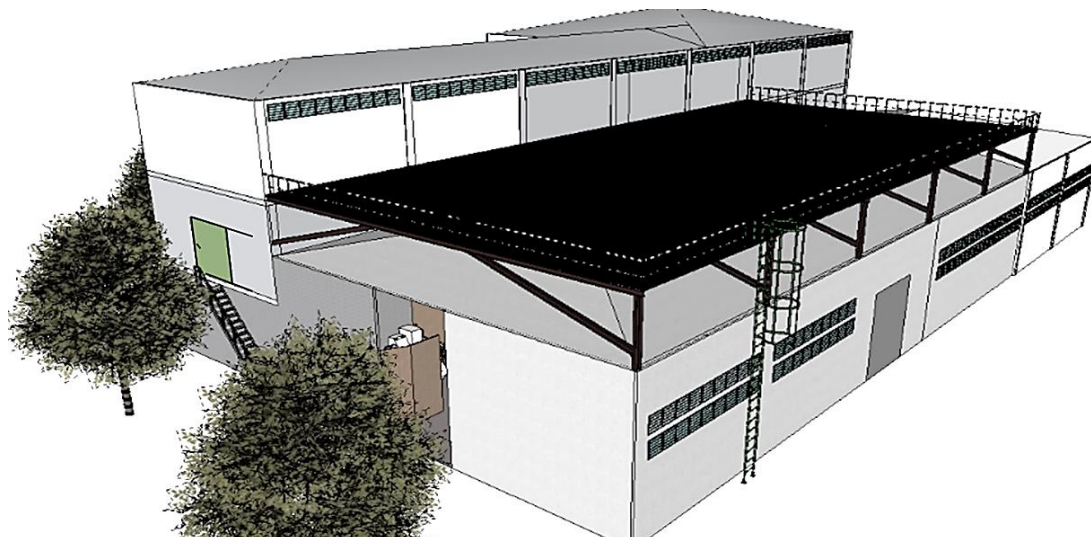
Modelo propuesto para la instalación de una Planta Piloto.
